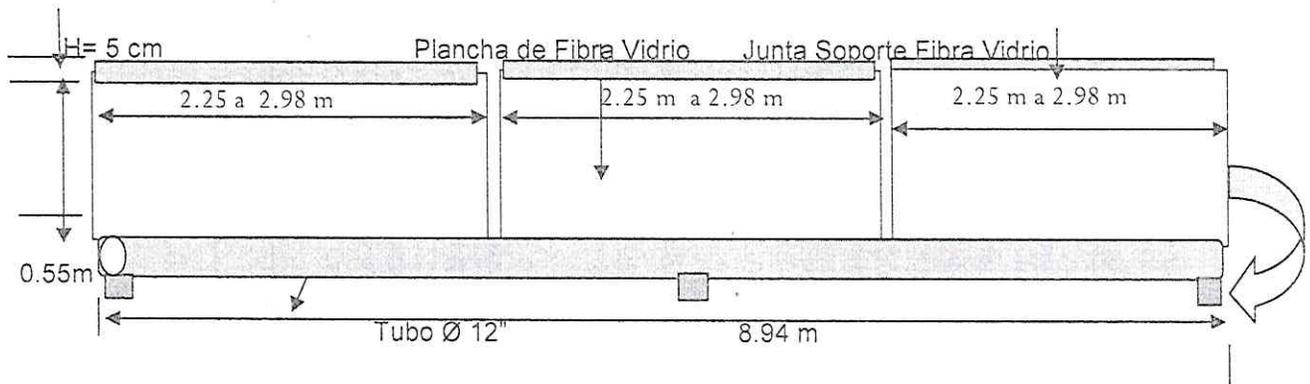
Lado lateral de la Plancha Tranquilizadora y en el lomo el soporte tipo "Juntas", ambos de Fibra de vidrio, instalado sobre el soporte móvil de concreto, este ubicado a un costado y sobre el lomo del ducto o tubos de material asbesto cemento Ø 12" de ingreso de agua mezclada con insumo químico en cada unidad del módulo del Decantador. Las planchas tranquilizadoras se ubican en el centro entre dos tubos Ø 12" en forma paralela
